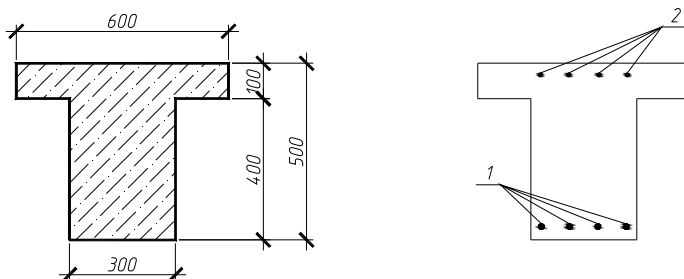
Сечение железобетонного элемента (монтажная и поперечная арматура условно не показаны)
